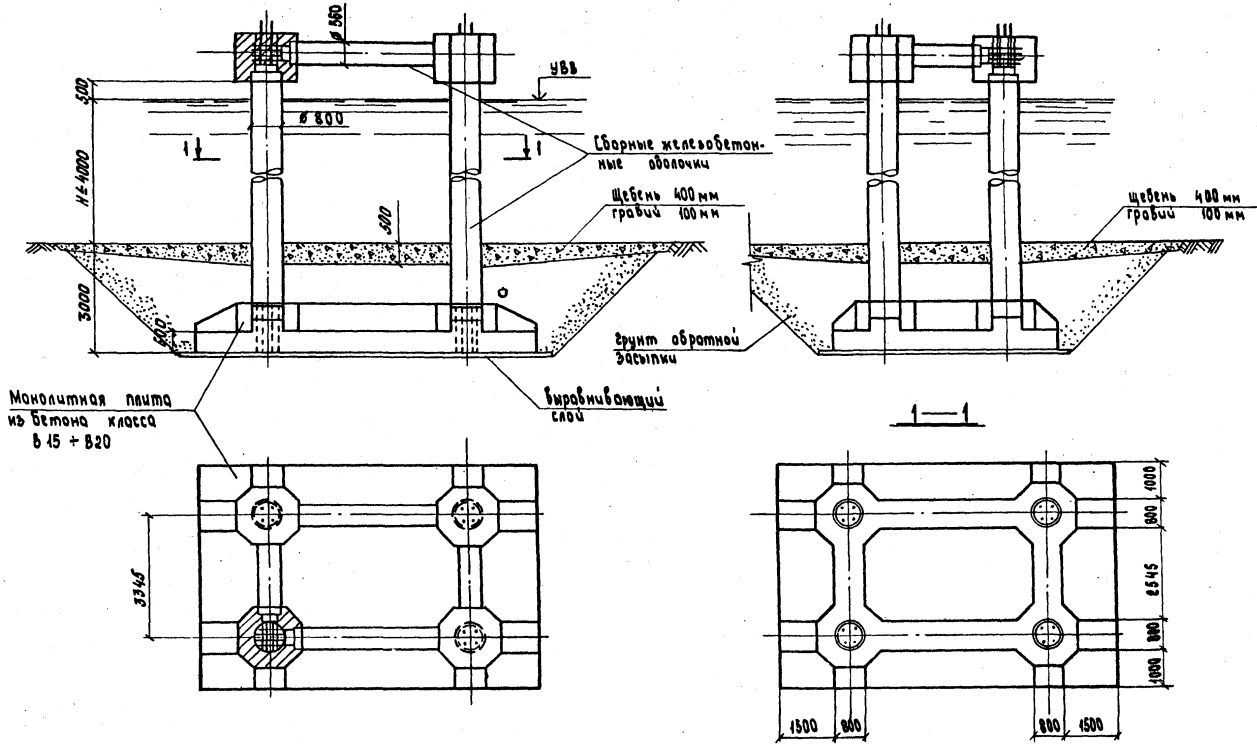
Единый сплошной фундамент под опоры. Вариант с рамным соединением стоек.
